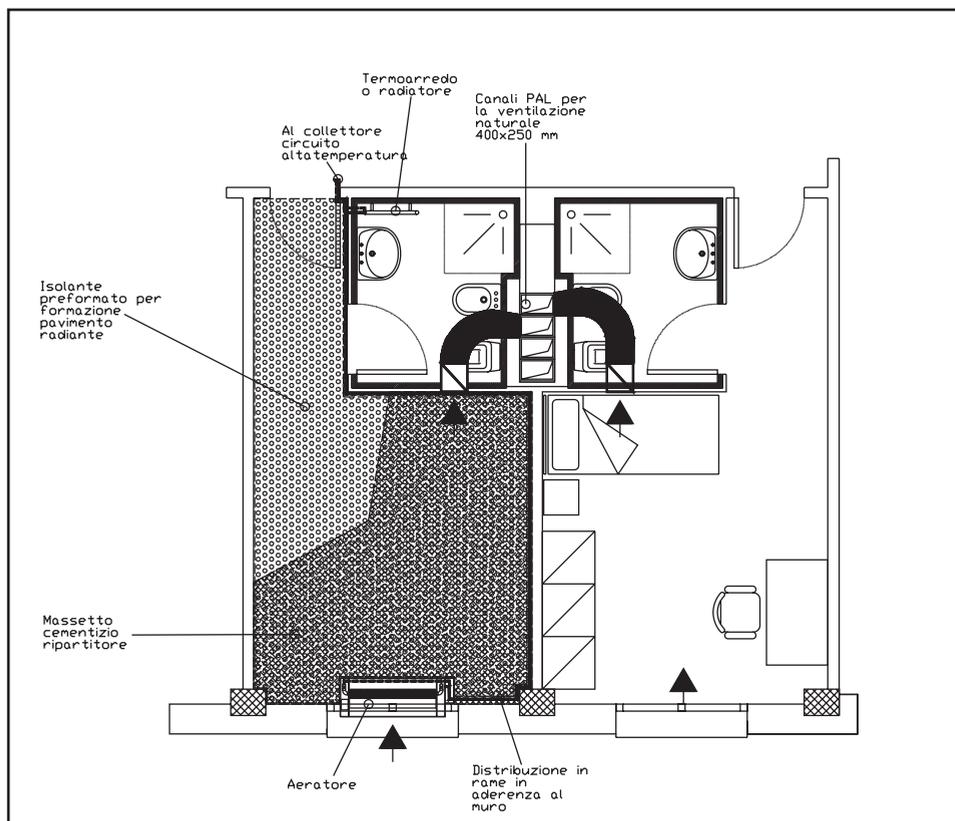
Estratto di pianta tipo: 2 stanze condividono un cavedio
